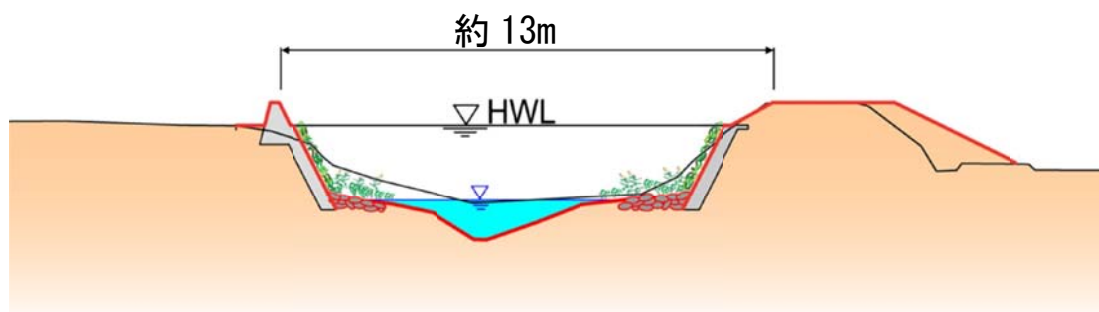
馬場川整備計画平面図（工事施行の場所）及び代表断面図
